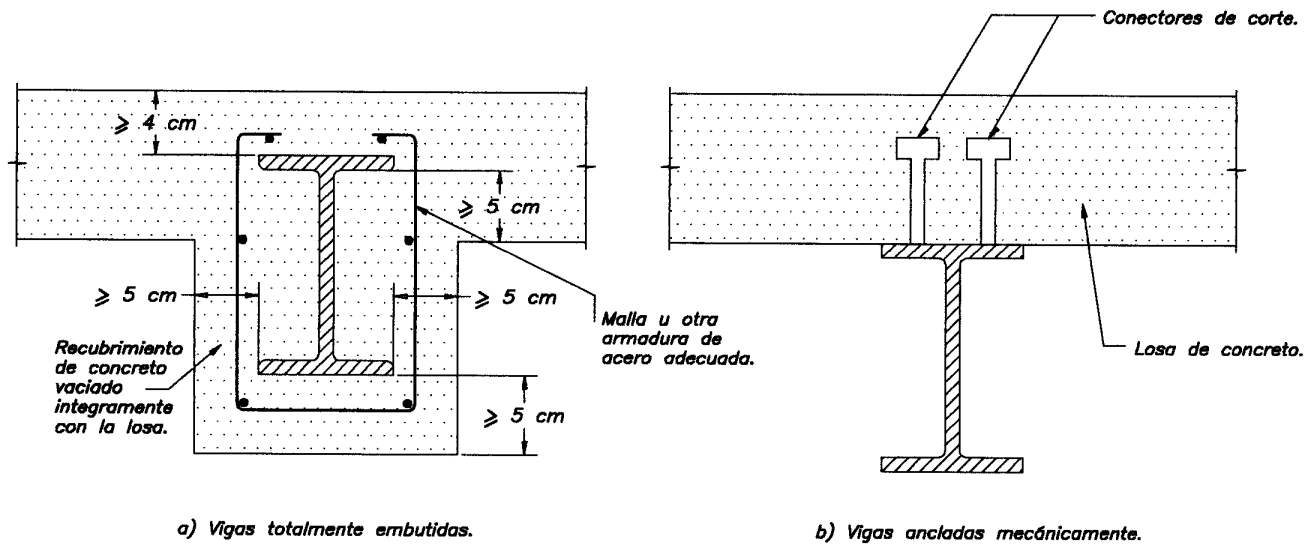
Vigas de sección mixta acero-concreto.
